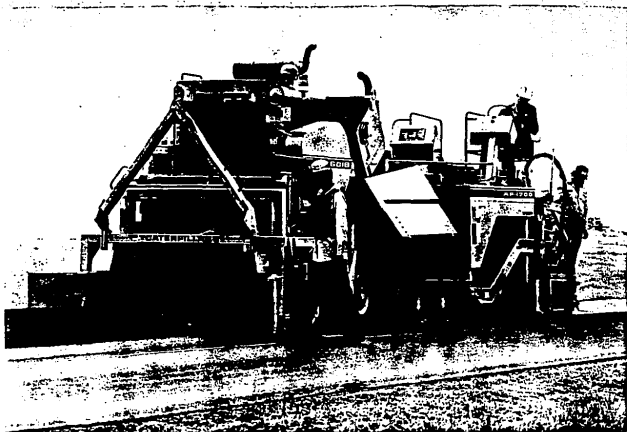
Máquina extendora de concreto asfáltico que previamente fue scordonado.
